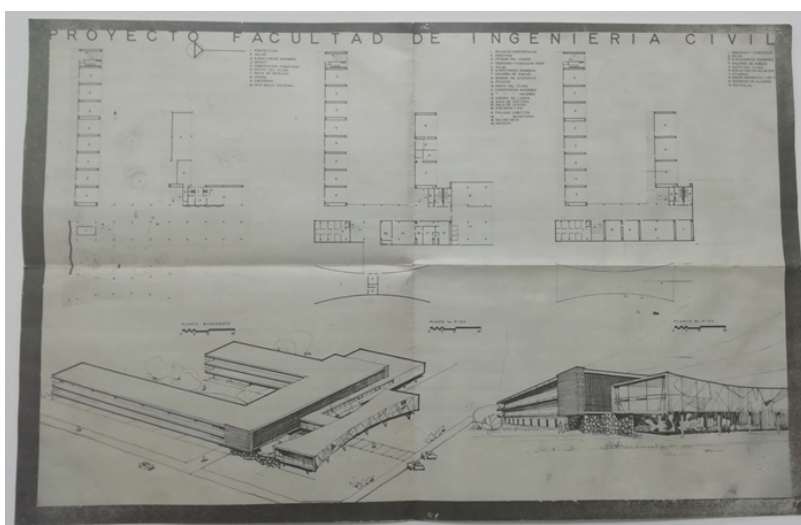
Plano proyecto de la Facultad de Ingeniería Civil; se observa el “adorno” en la fachada cóncava, lo que confirma que si se contemplaba algún tipo de ornamento. Fuente: Archivo Manuel L. Barragán-Patronato Universitario (AMLB-PU; archivo particular).
